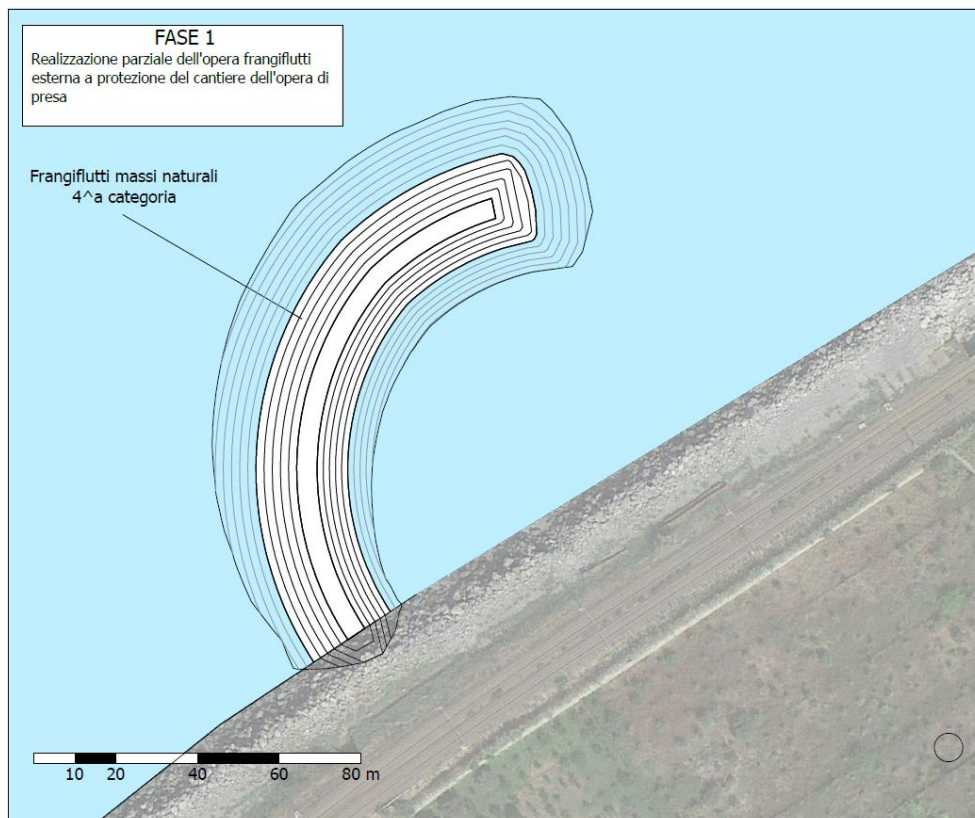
Fase 1: Realizzazione parziale dell'opera frangiflutti esterna a protezione del cantiere dell'opera di presa
